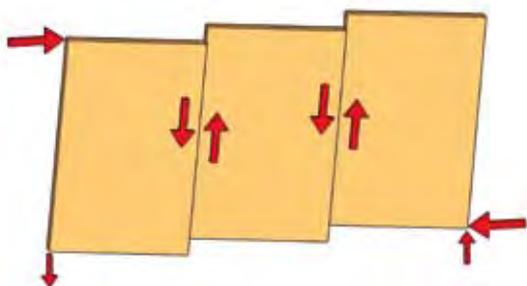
Distribuzione forze tra elementi della stessa parete
